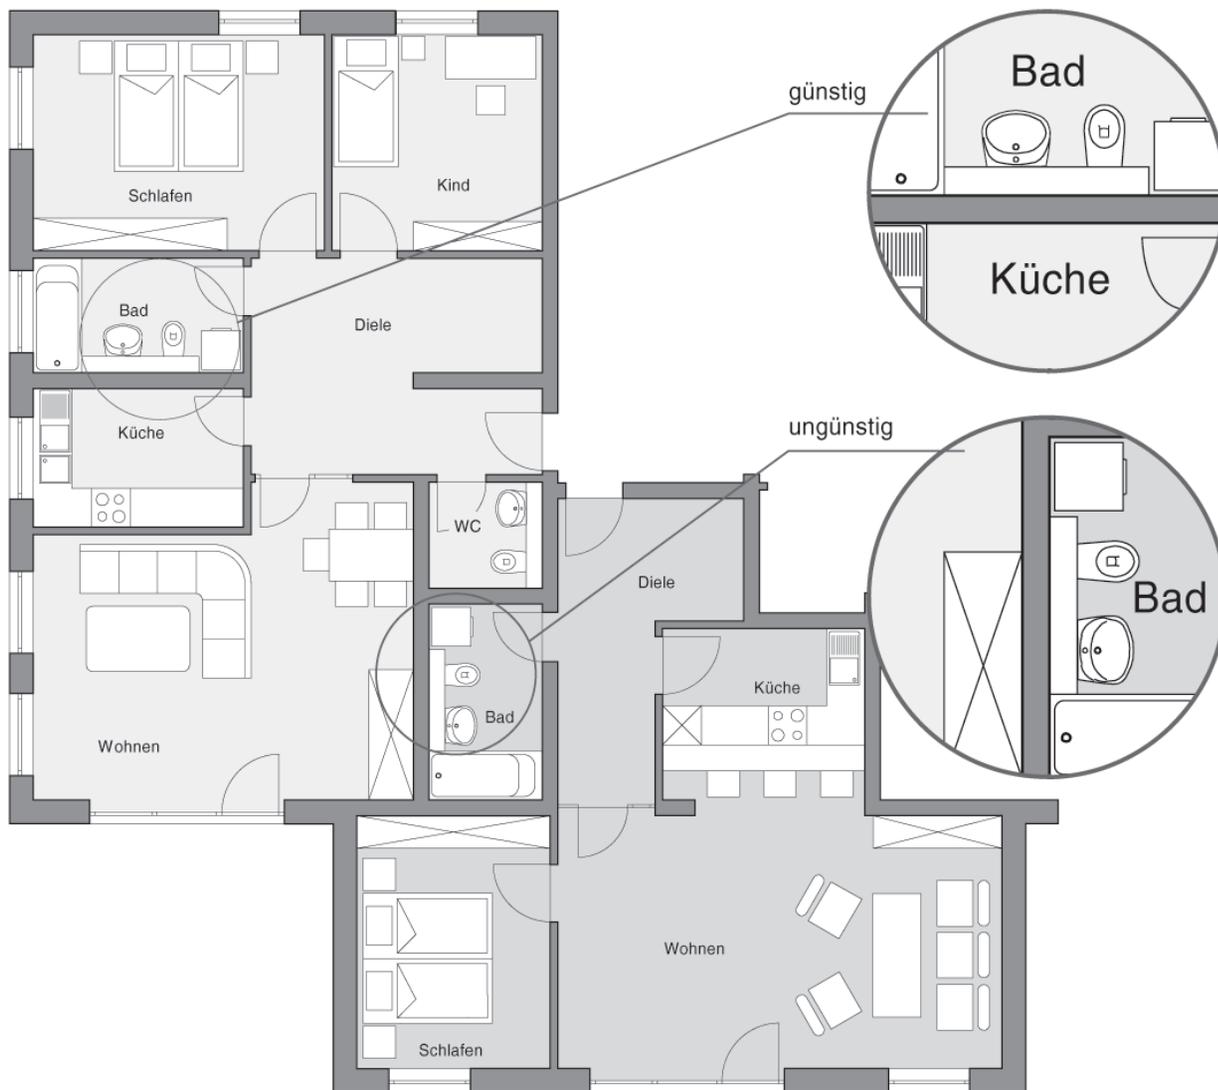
Beispiel einer Grundrissplanung, Draufsicht
